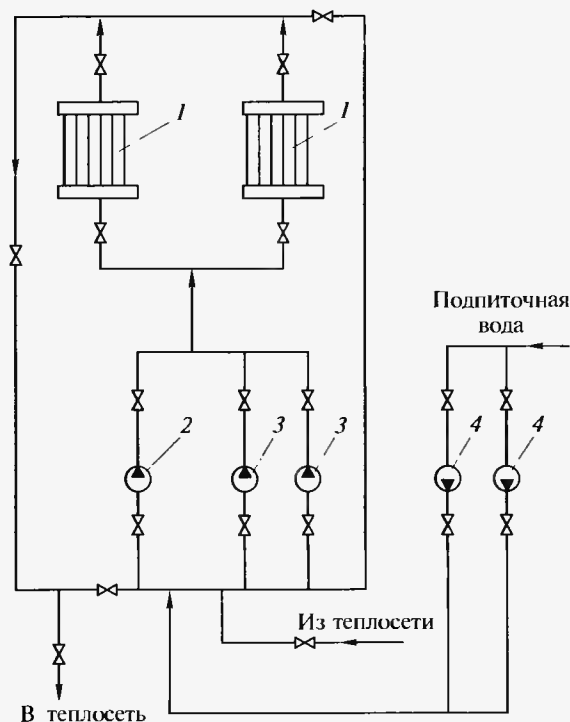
Схема присоединения питательных трубопроводов к водогрейным котлам:
